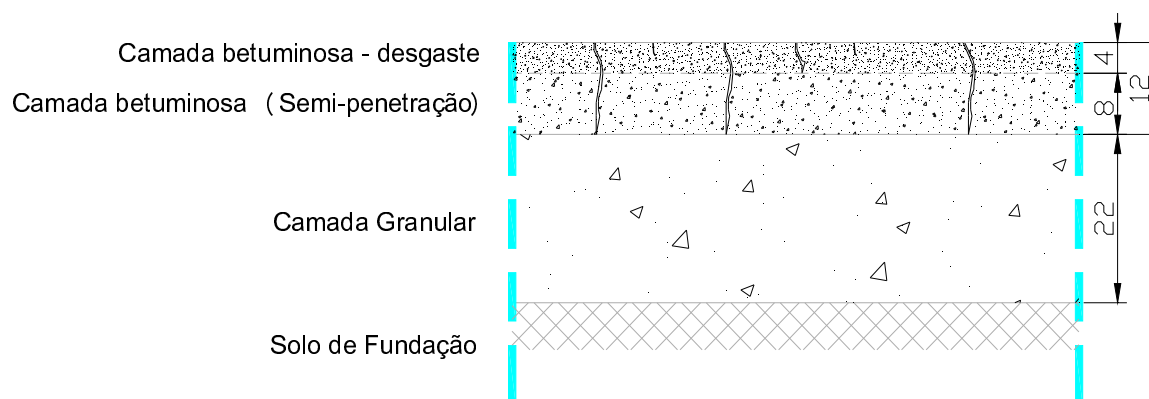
Geometria do pavimento da Rua Associação Artística Vimaranesse
